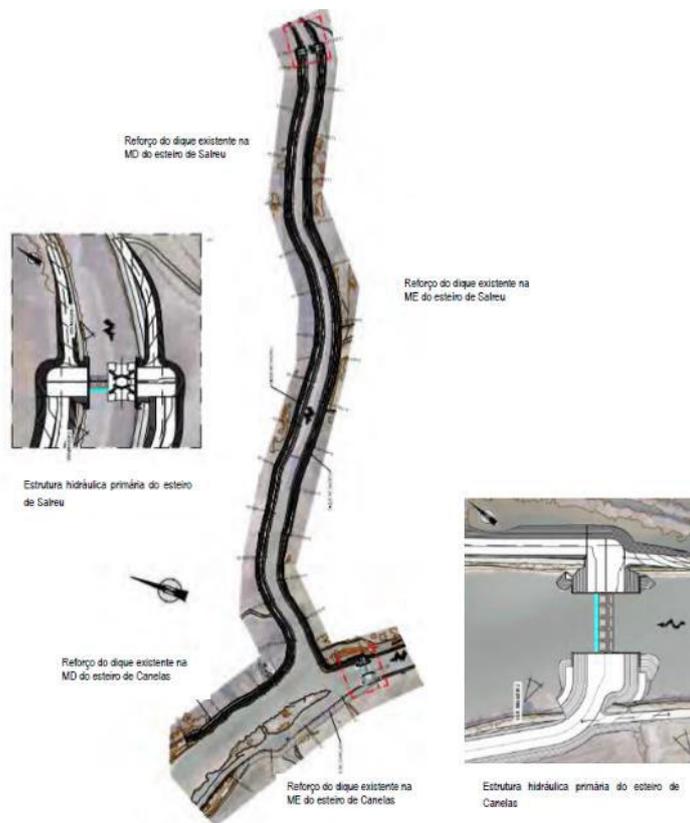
Planta geral do Dique dos esteiros de Canelas e de Salreu e pormenor das estruturas hidráulicas primárias do esteiro de Canelas (EHP3) e do esteiro de Salreu (EHP4)
